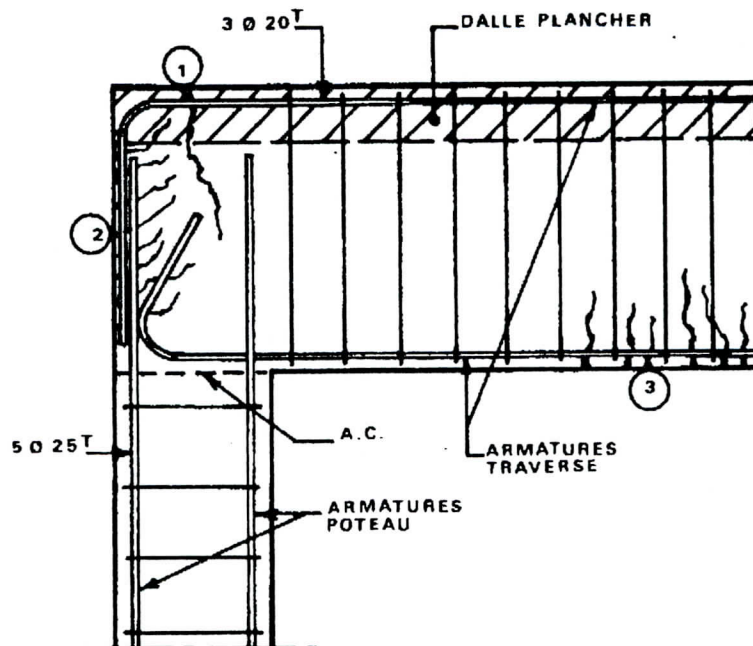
Disposition prévue incorrecte : Liaison poteau - poutre [1]
